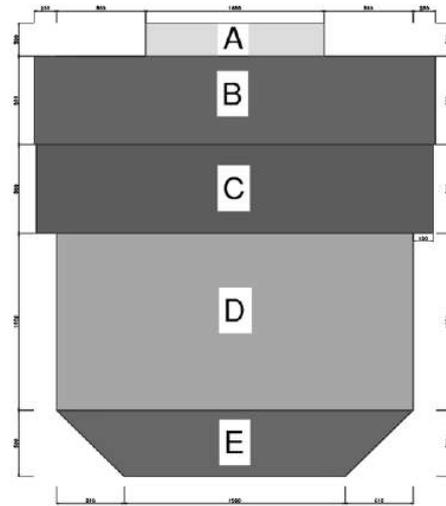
Rencana Denah Lantai 2 Aula (Konvensional)
